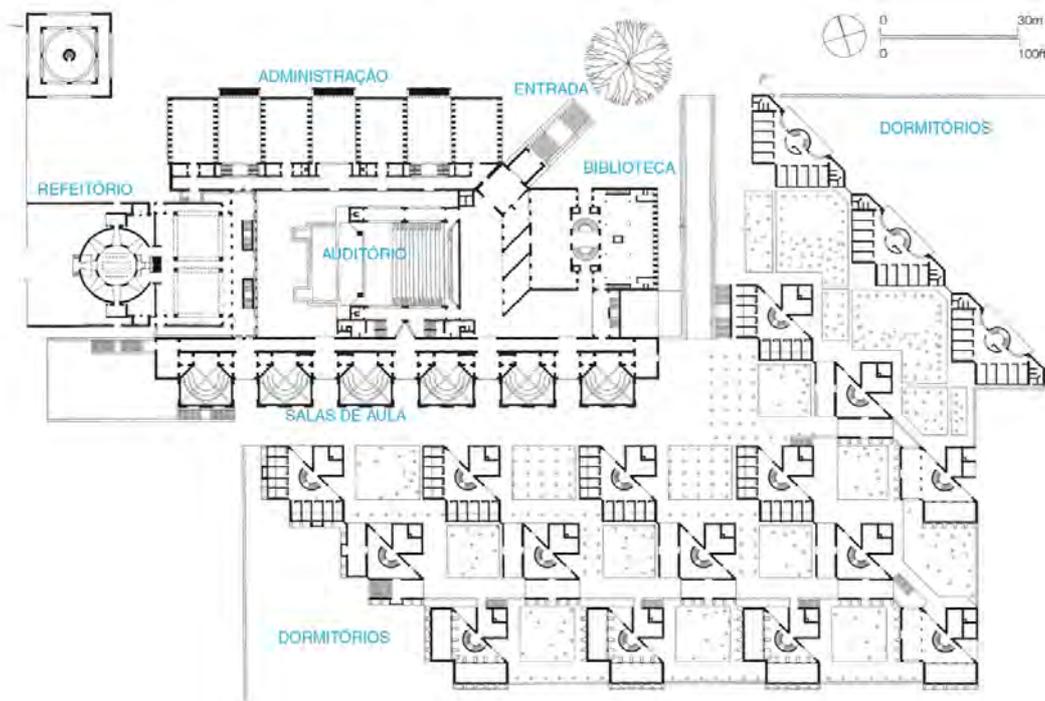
| Planta geral Instituto Indiano [McCARTER]
